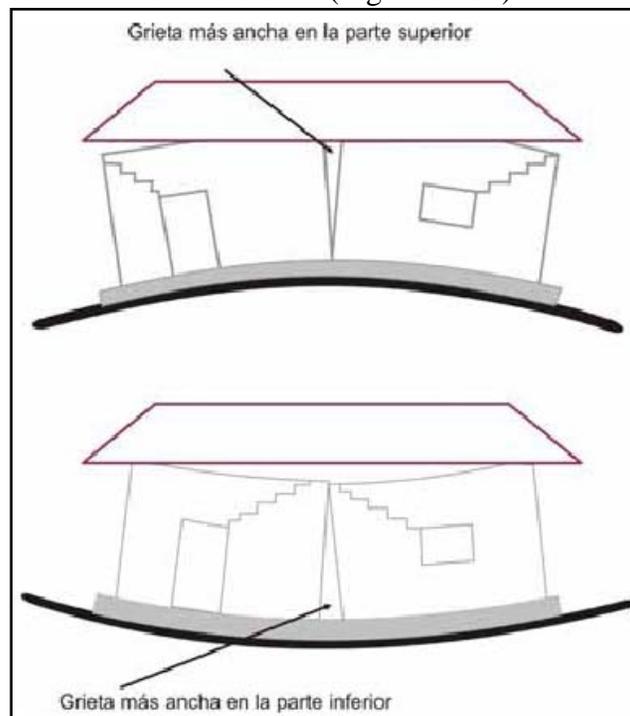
Aparición de fisuras y grietas por desestabilización de suelos. Fuente: Ciser
